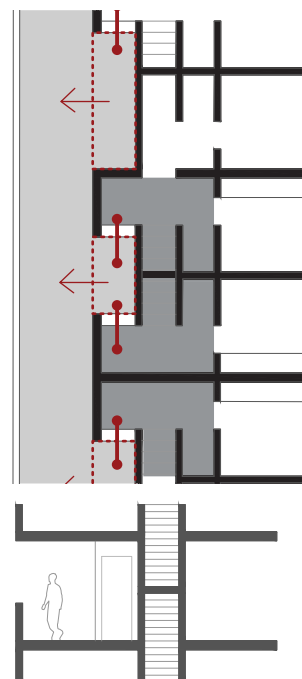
Acesso aos fogos, Robin Hood Gardens. Planta e corte Escala 1:200.
